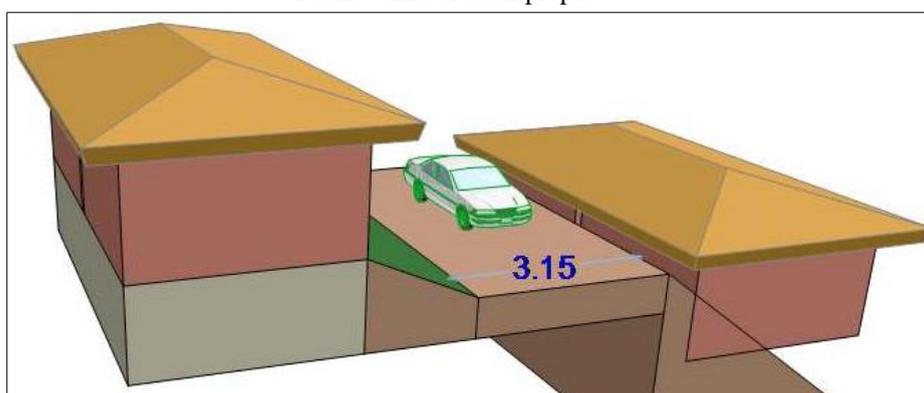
Vista 3d de Sección de vía Pedro Ruiz Gallo.
